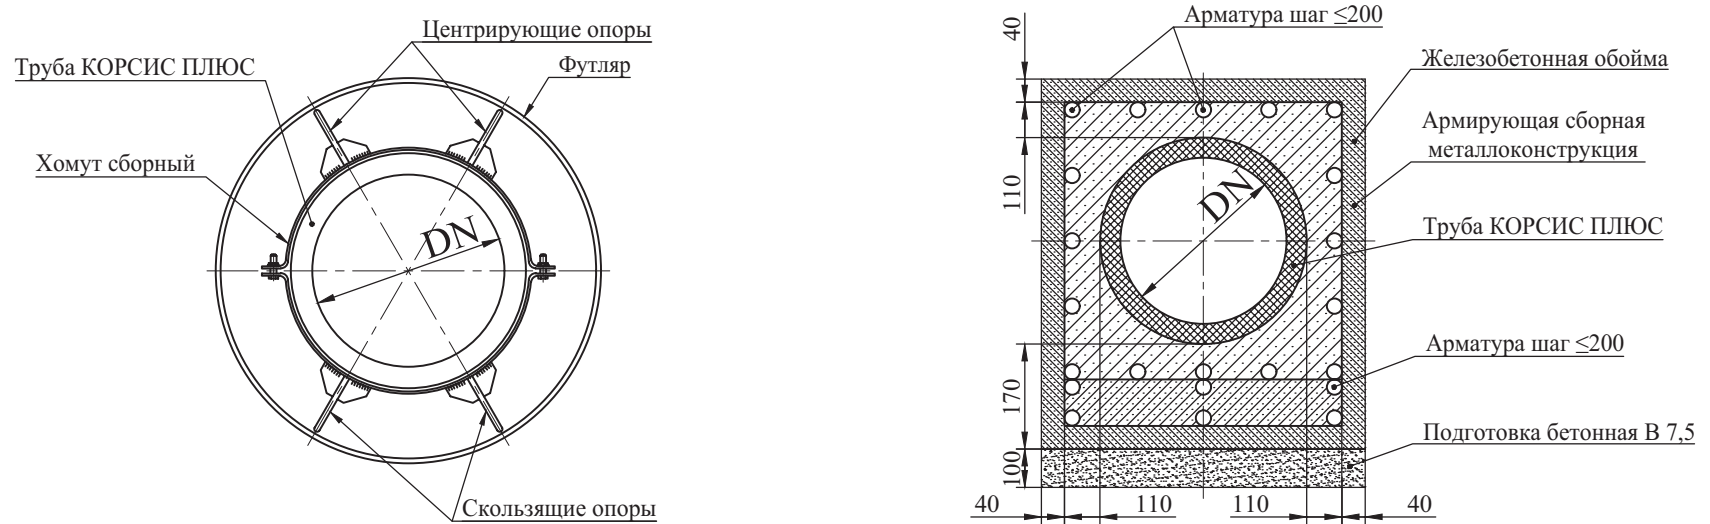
Укладка труб КОРСИС ПЛЮС в футляре или железобетонной обойме
